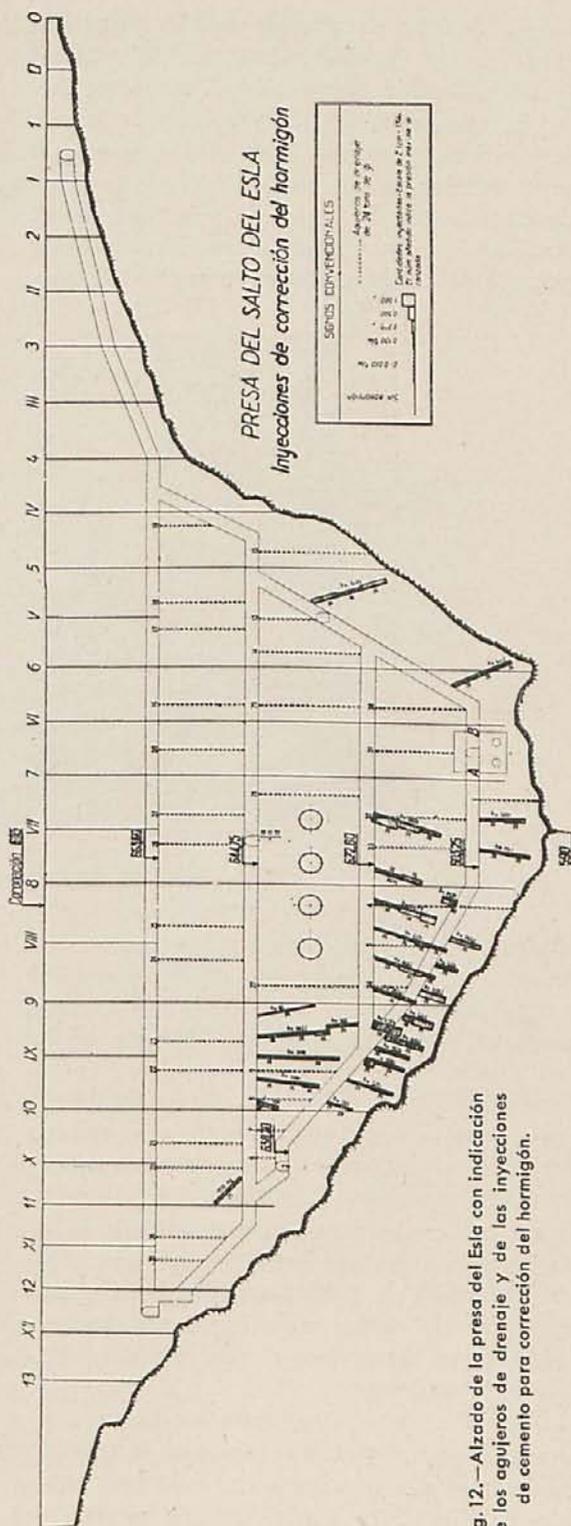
Alzado de la presa del Esla con indicación de los agujeros de drenaje y de las inyecciones de cemento para corrección del hormigón.
